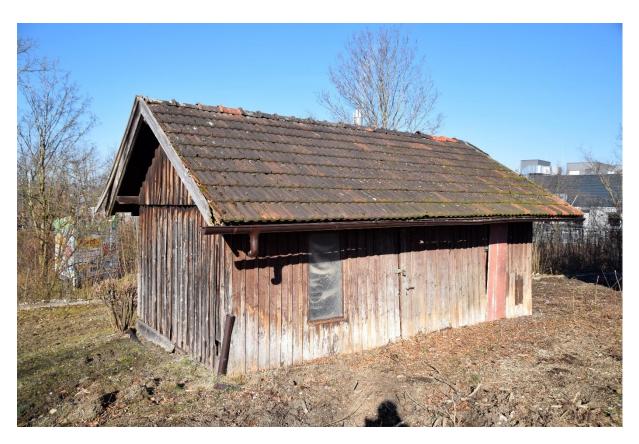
Baufälliger Holzschuppen südwestlich des Gebäudes
